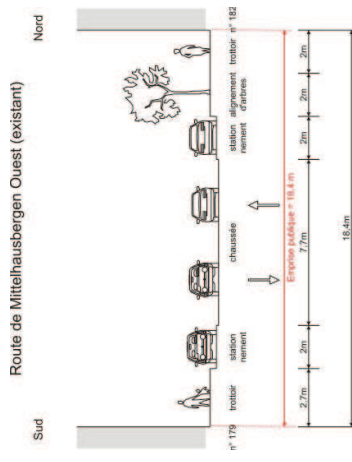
Situation existante. Coupe du point dur d'insertion de la variante V3, rue de Mittelhausbergen.
